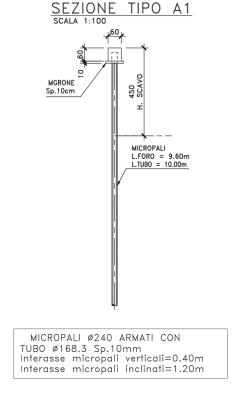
Sezione Paratia "Sezione tipo A1"
